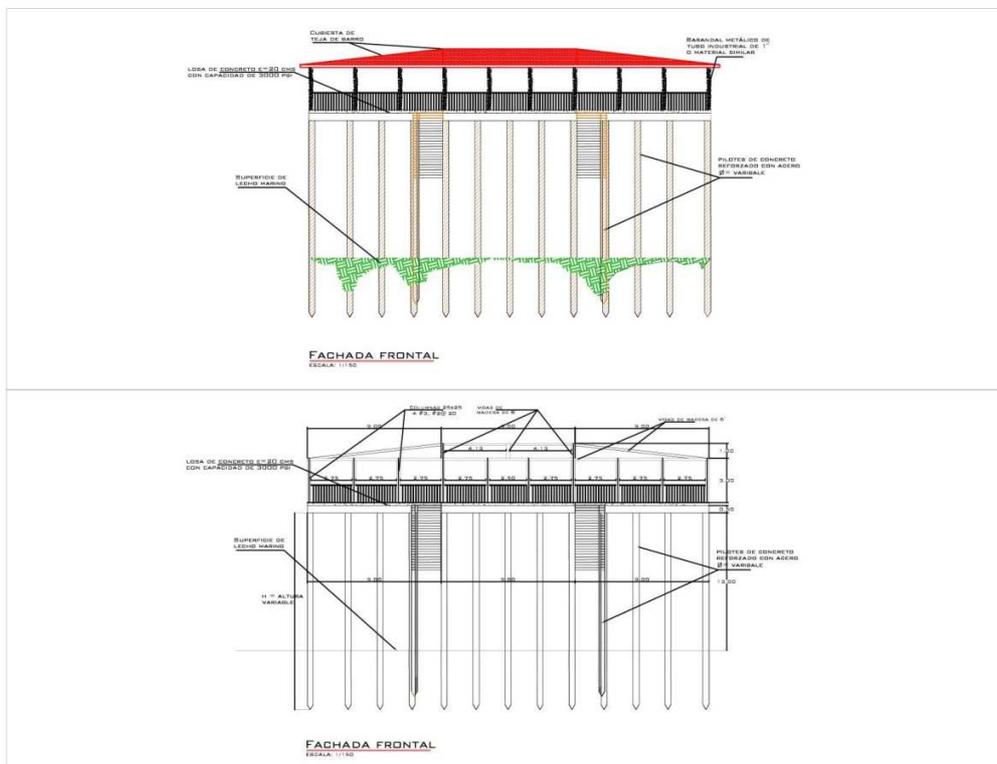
Fachada Frontal con propuesta de muelle con pilotes.
